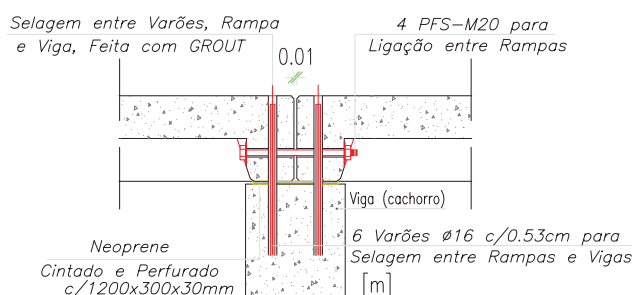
Pormenor de selagem entre a viga e as rampas [62]
